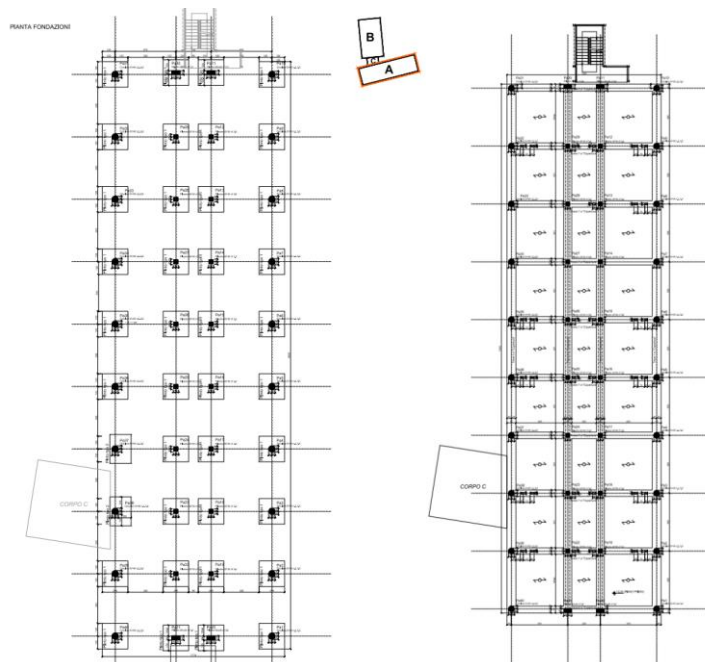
Pianta fondazioni (sinistra) e piano primo (destra) corpo A
